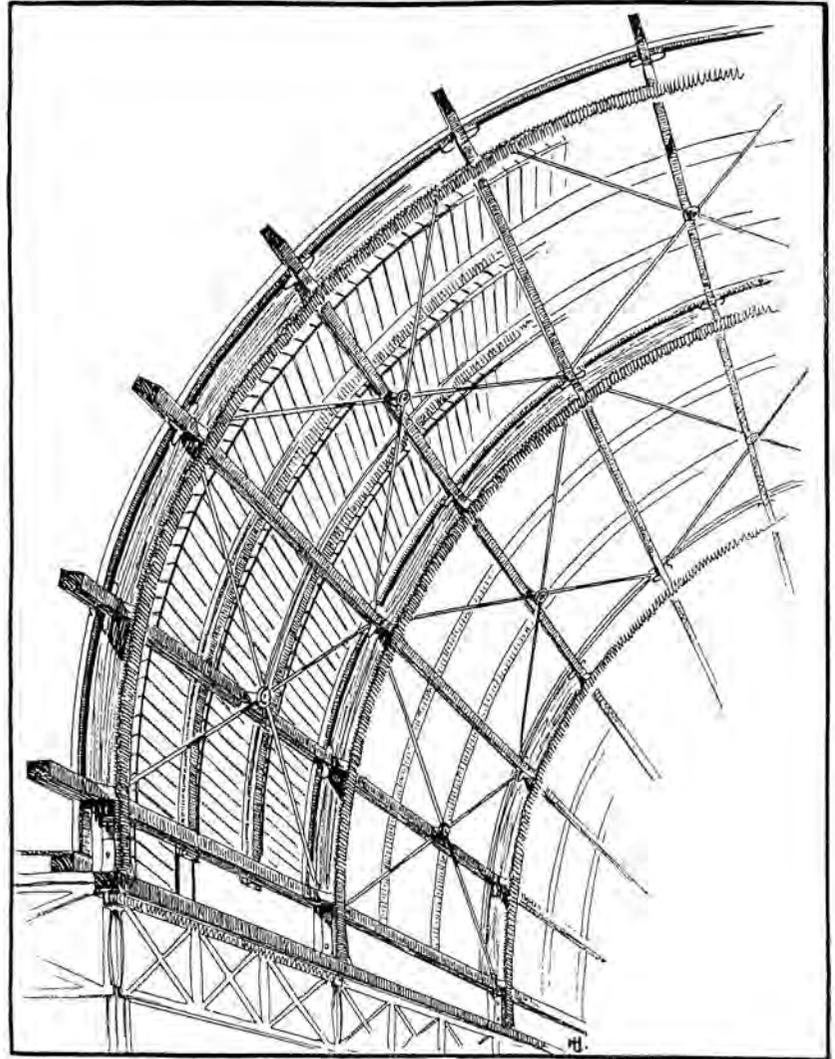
Kristallpalast London, 1851, Konstruktion der Holzbögen und Verbände aus Eisen, aus /98/
